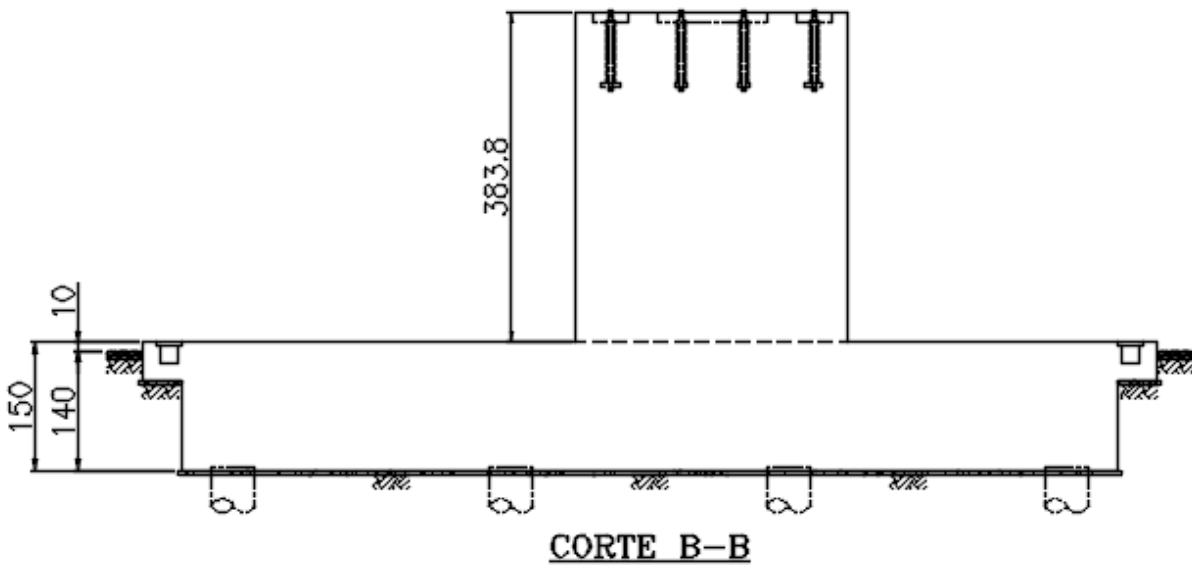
Modelo estrutural: elevação da fundação (Corte B-B)
